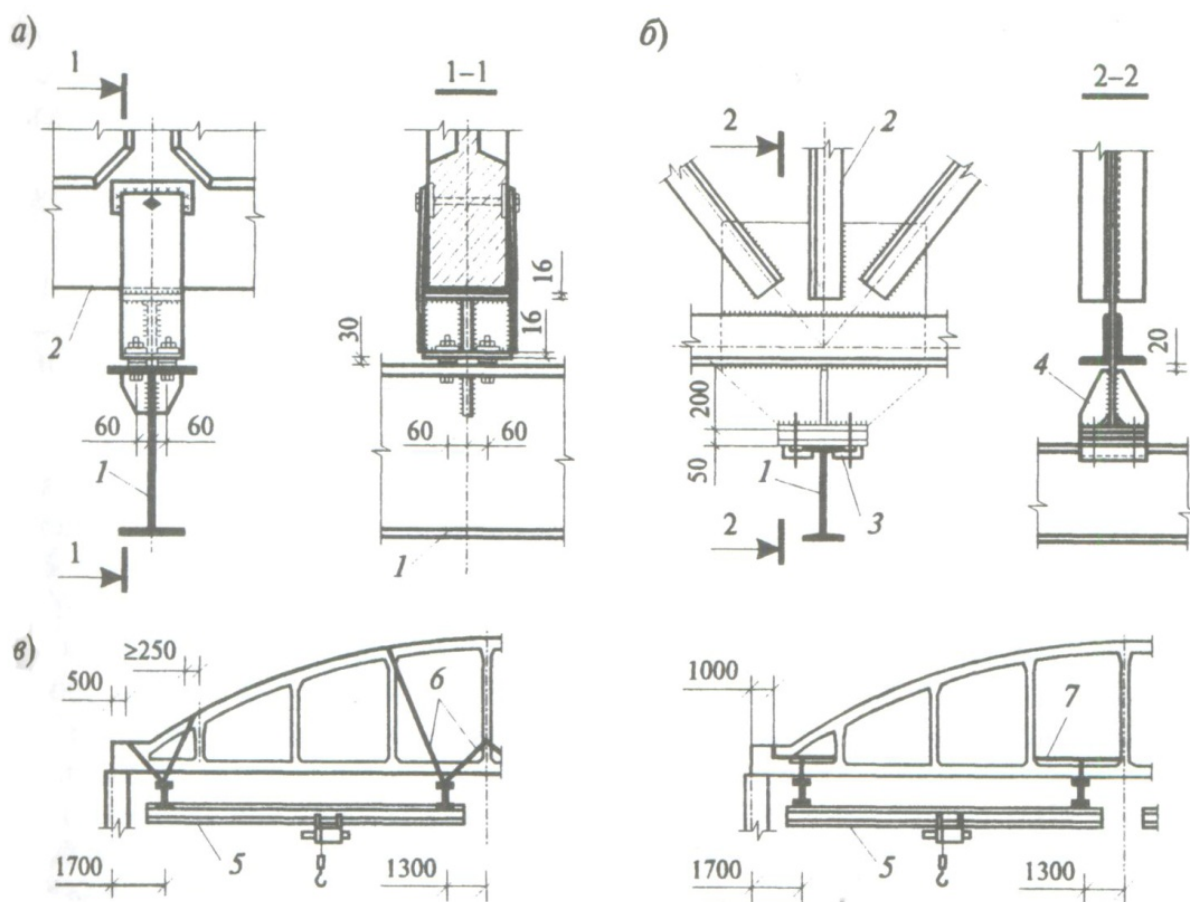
Способы крепления подвесных путей к стропильным конструкциям:
